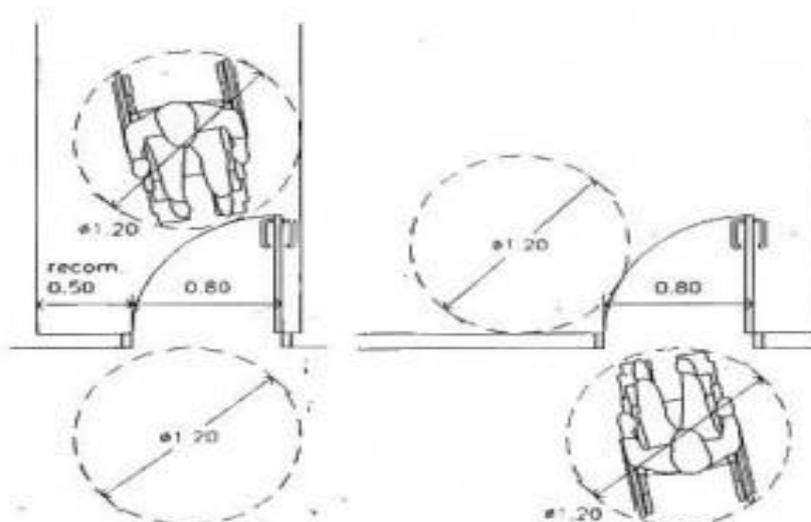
Puertas de Acceso Fuente: (Pierre, 2003)
